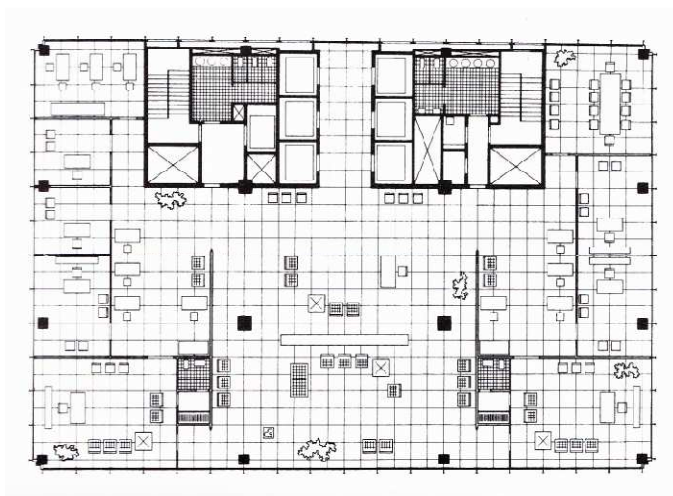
Planta Baixa | Pavimento Tipo Office Tower. (FONTE: CARTER, 1999).
